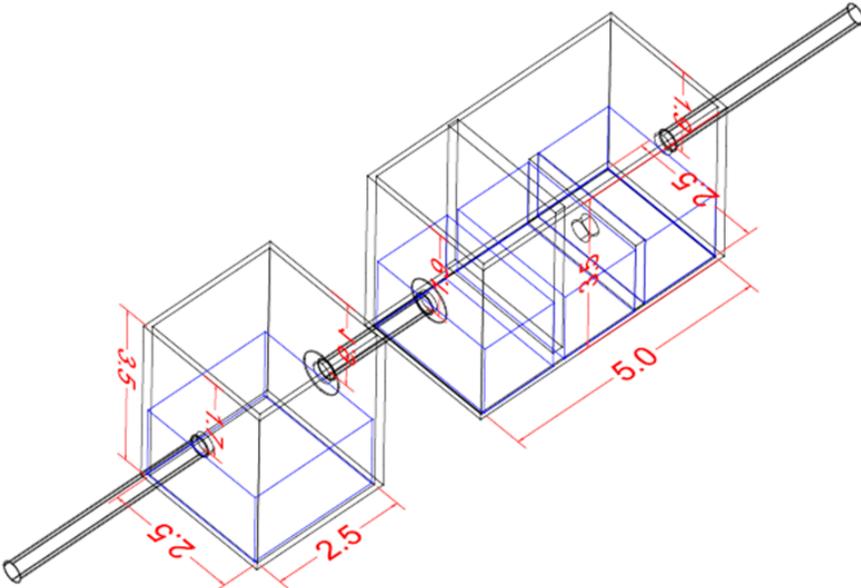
Estanques de la PTAR vista estructural SO. Fuente: creación propia.
